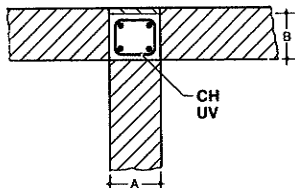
Coupe verticale schématique montrant les chaînages horizontaux de planchers et les chaînages verticaux.
